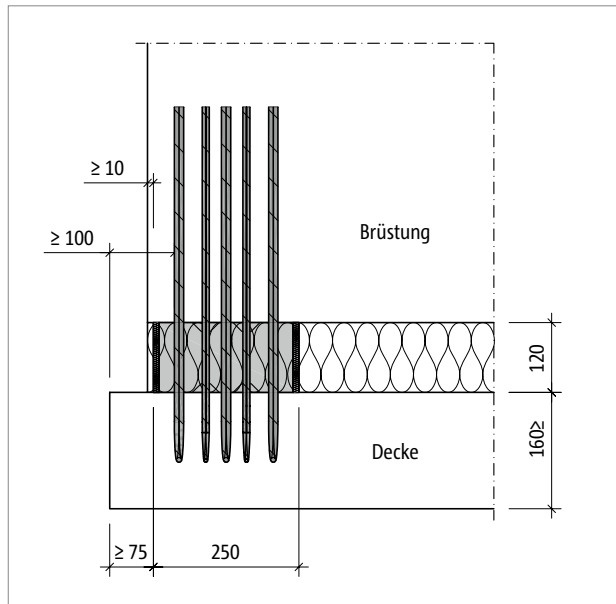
Schöck Isokorb® XT/T Typ AP vertikale Anordnung: Ansicht Randabstände
